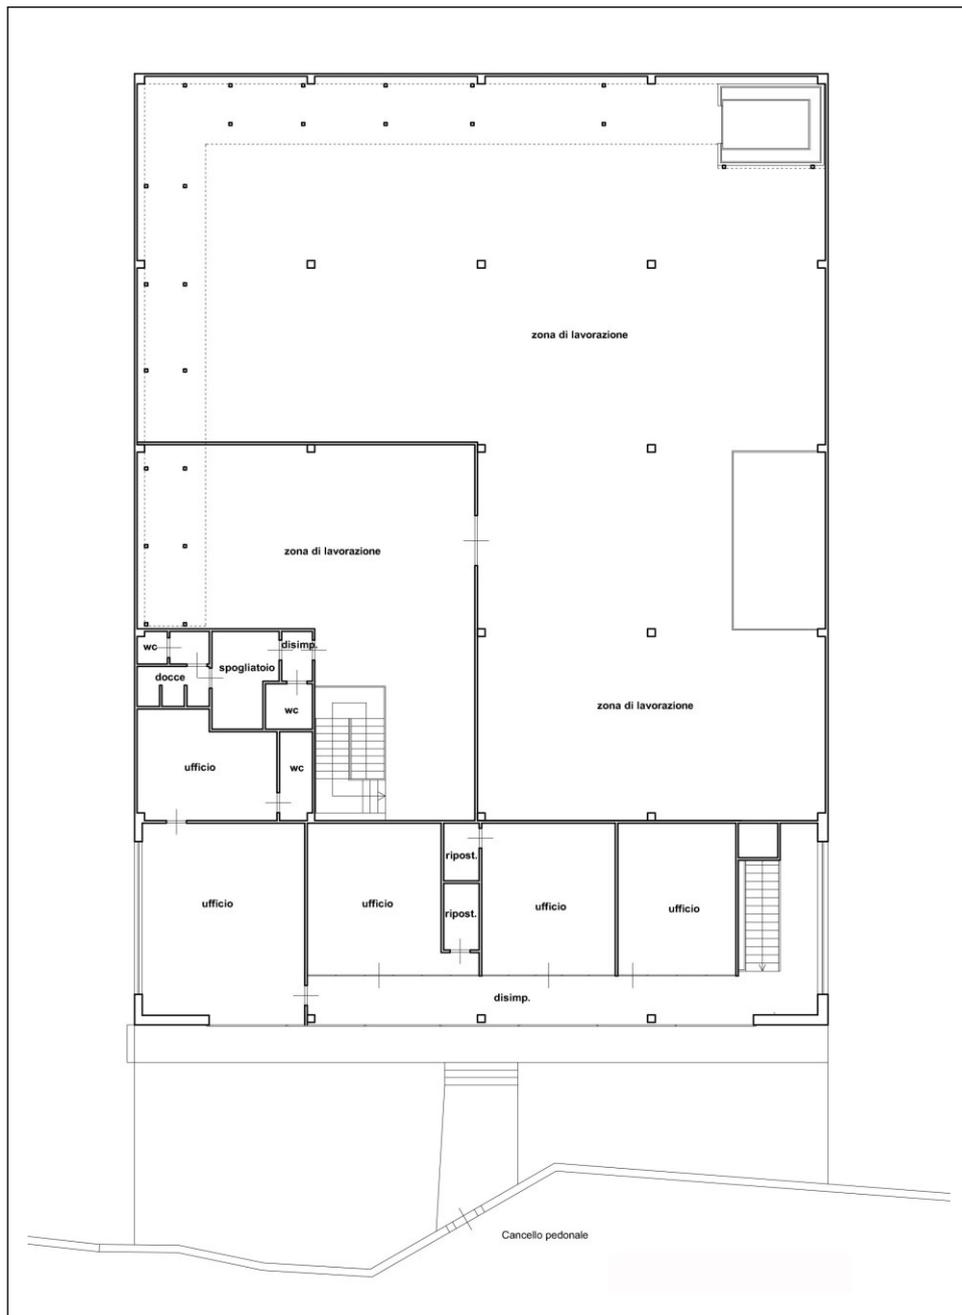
Rilievo dello stato di fatto del primo piano.
